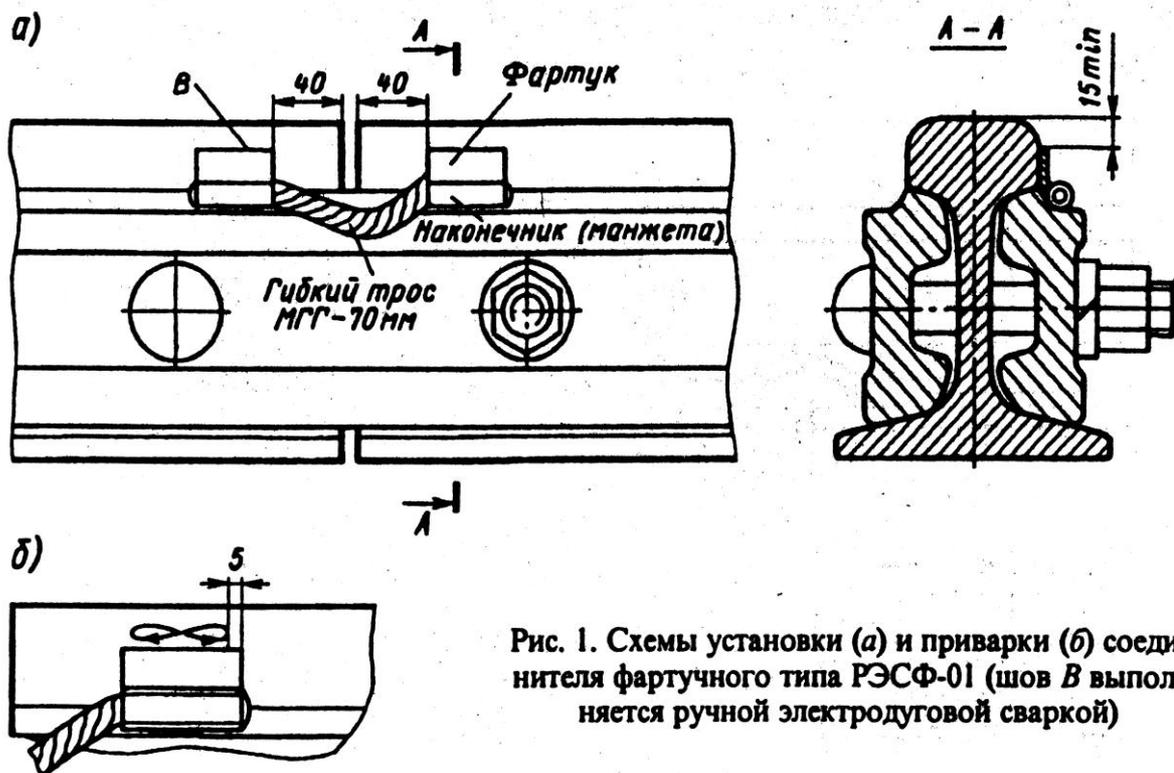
Схемы установки (а) и приварки (б) соединителя фартучного типа РЭСФ-01 (швы В выполняется ручной электродуговой сваркой)
